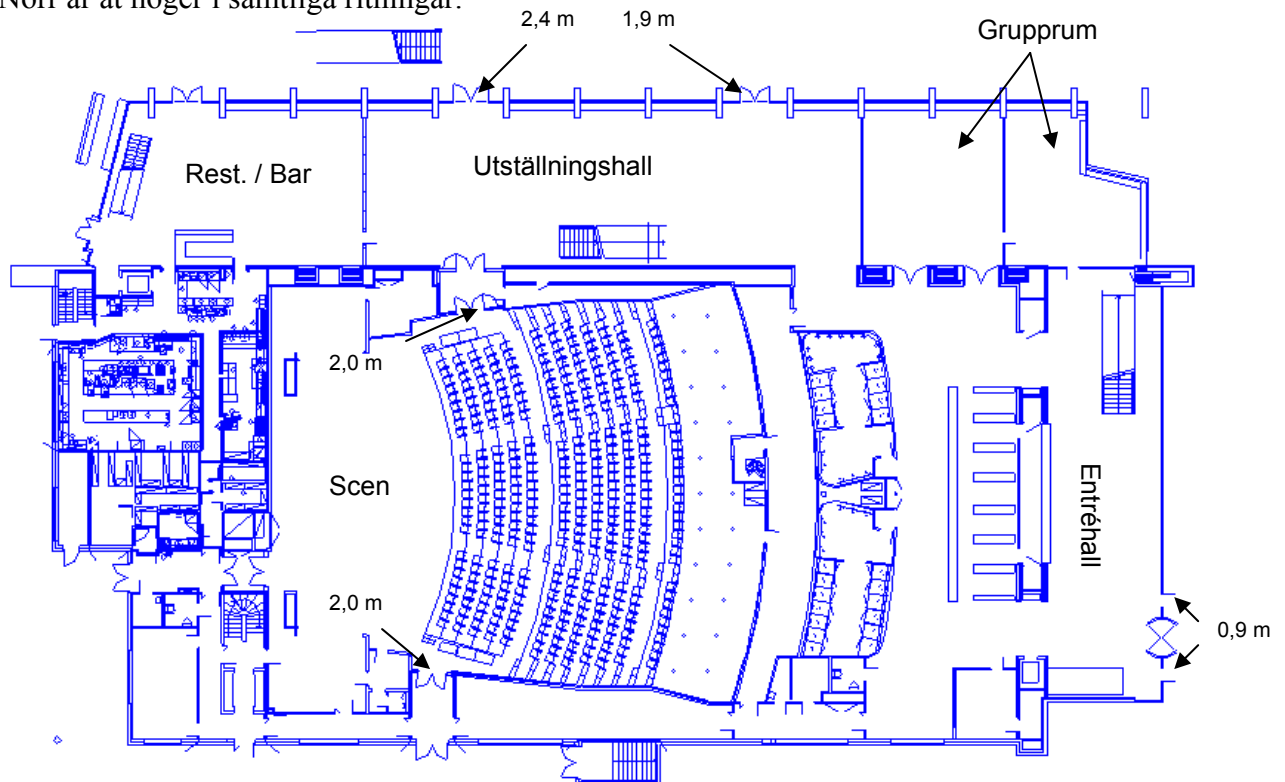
Plan 2 – Markplan med entré, utställningshall och kongresshallens nedre del mm.
